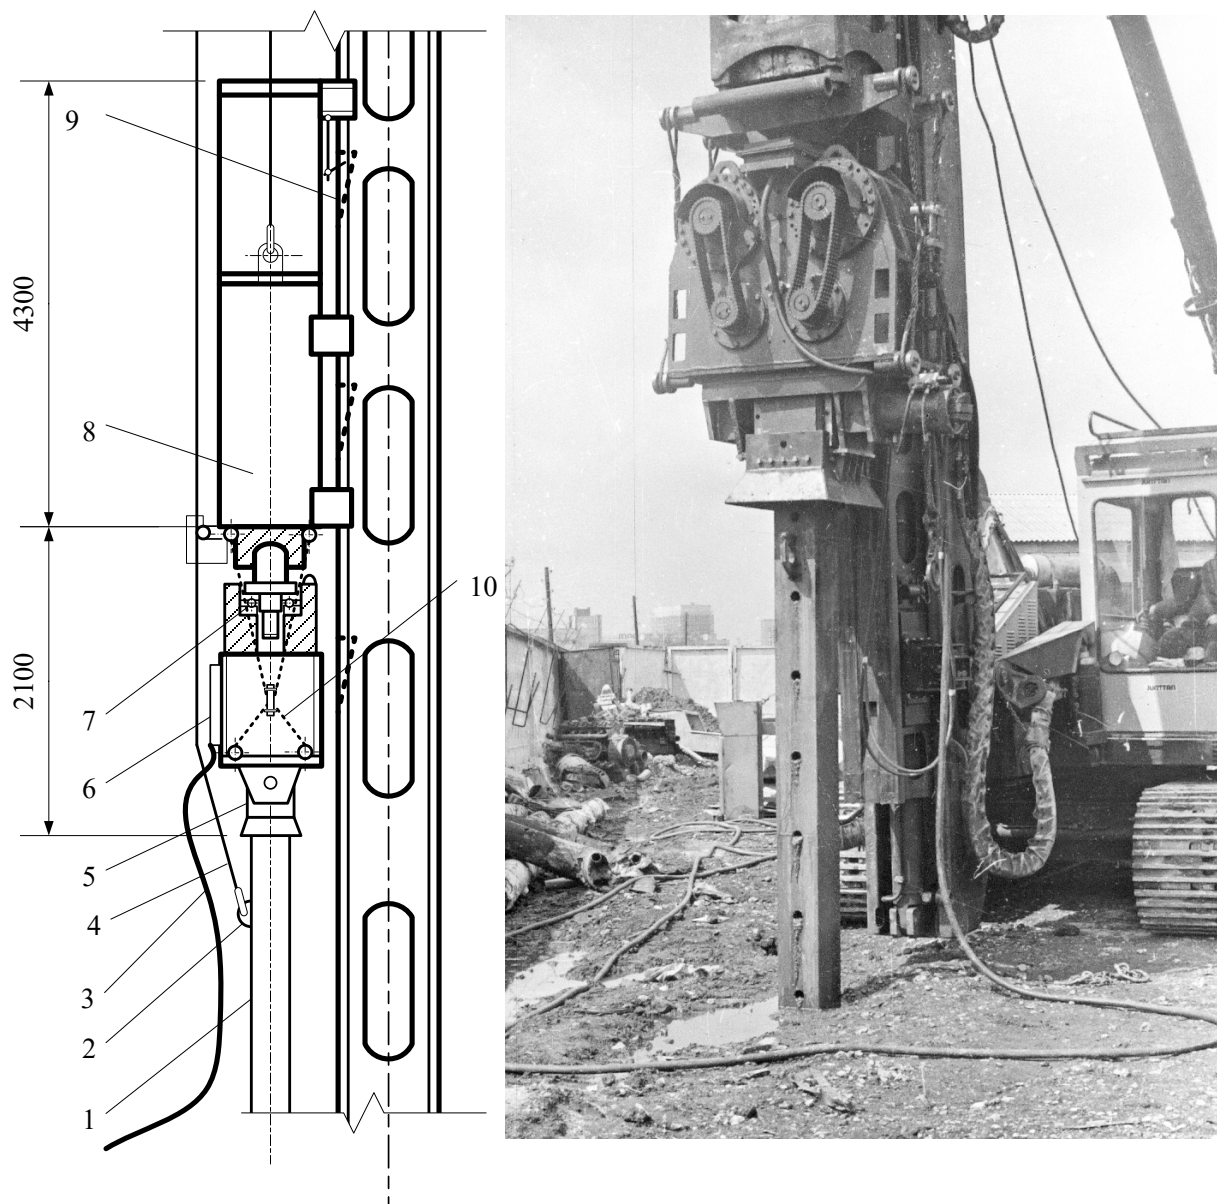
Экспериментальная установка на базе копра для вибрационного вдавливания свай: 1 – свая; 2 – строповочная петля на свае; 3 – силовой кабель вибропогружателя; 4 – грузовой канат копра; 5 – наголовник; 6 – вибропогружатель вращательных колебаний; 7 – подшипник с упором со сферической поверхностью; 8 – корпус молота; 9 – стрела копра с упорами для задавливания; 10 – перекрещивающиеся стропы крепления вибропогружателя к корпусу молота
